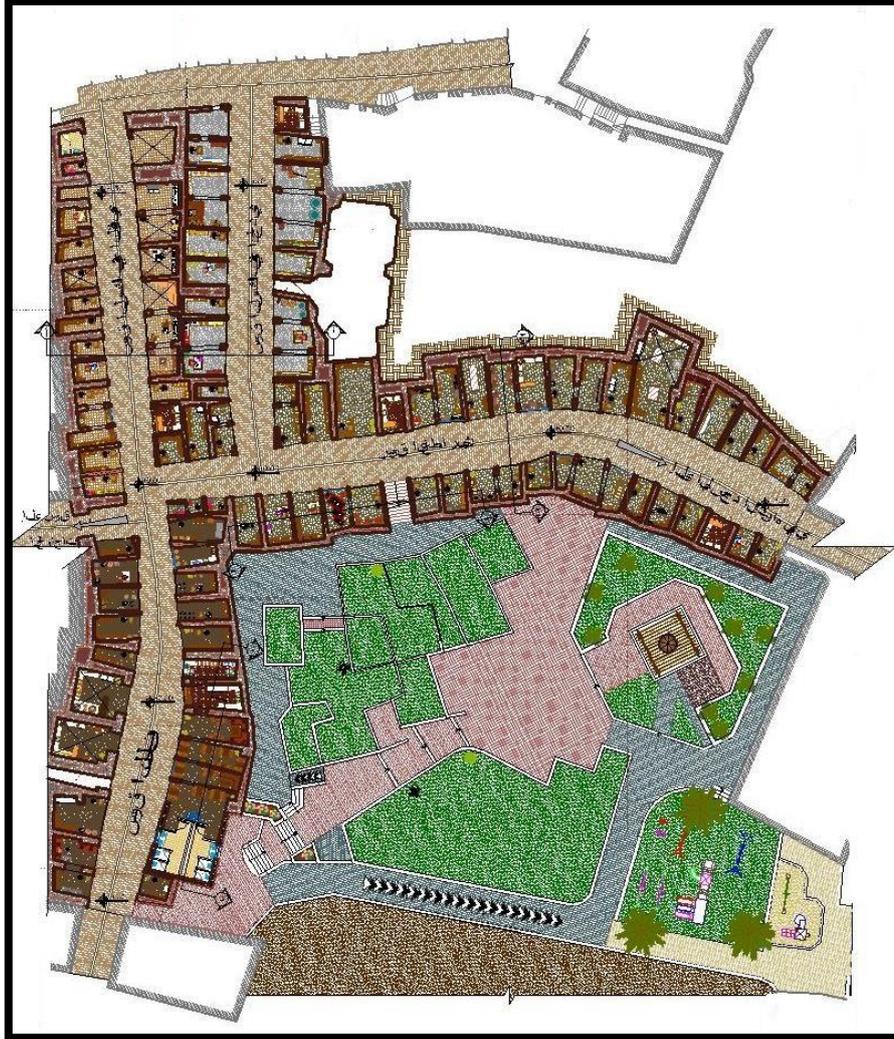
مخطط الطابق الأول لخان ابراهيم الخليل
